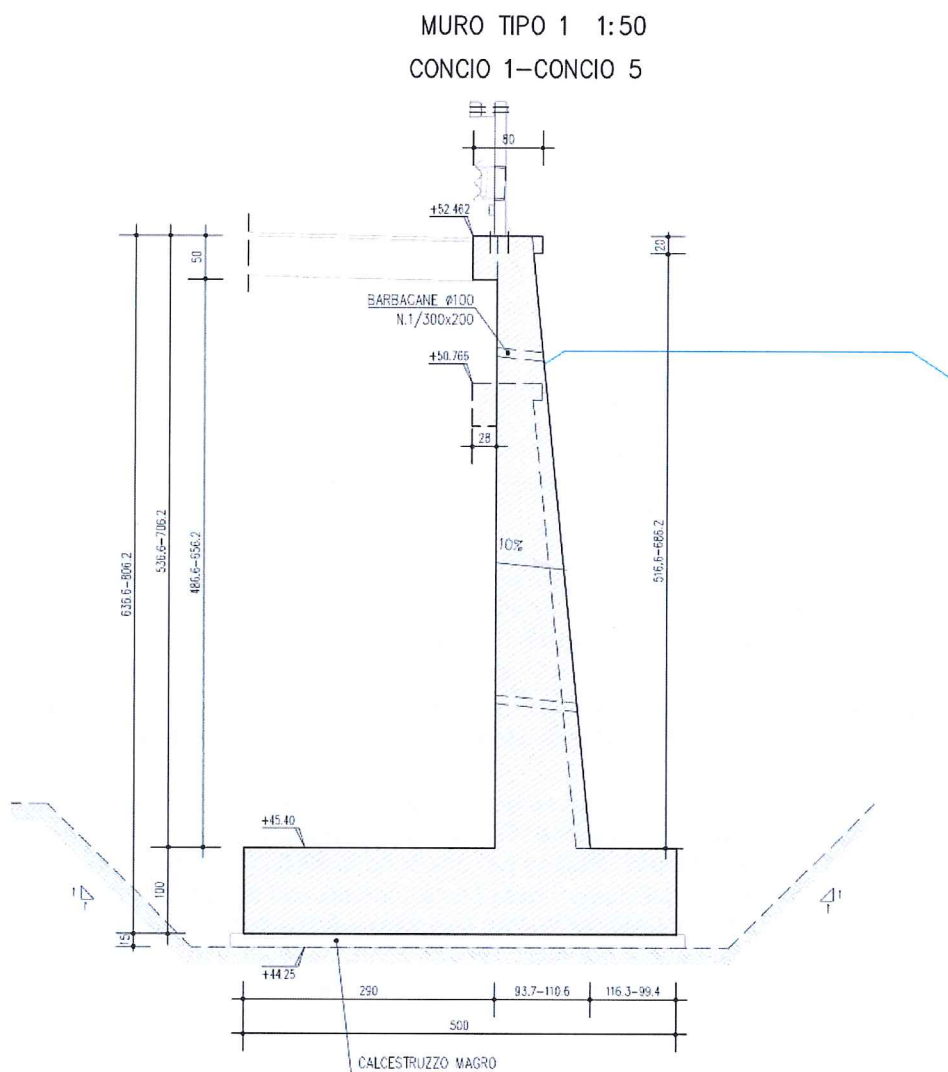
Sezione Tipo - Muro 1 Conci da 1 a 5
